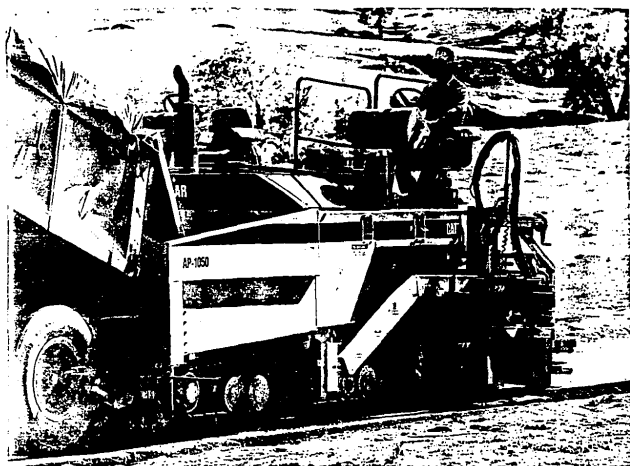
Camión que descarga el concreto asfáltico en la tolva de la extendidora.
